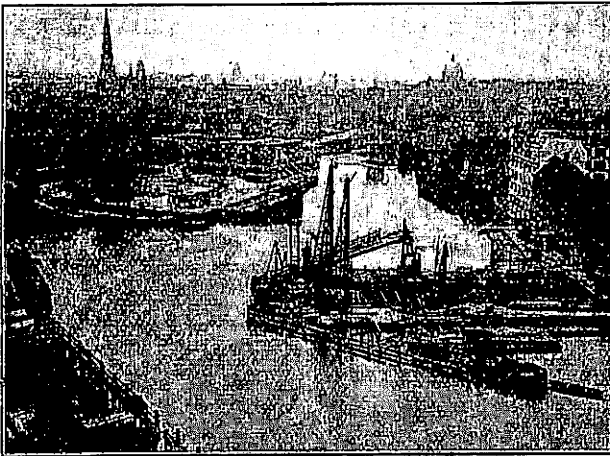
Spreekreuzung Inselbrücke, Bauabschnitt II (nach J. Bousset).
